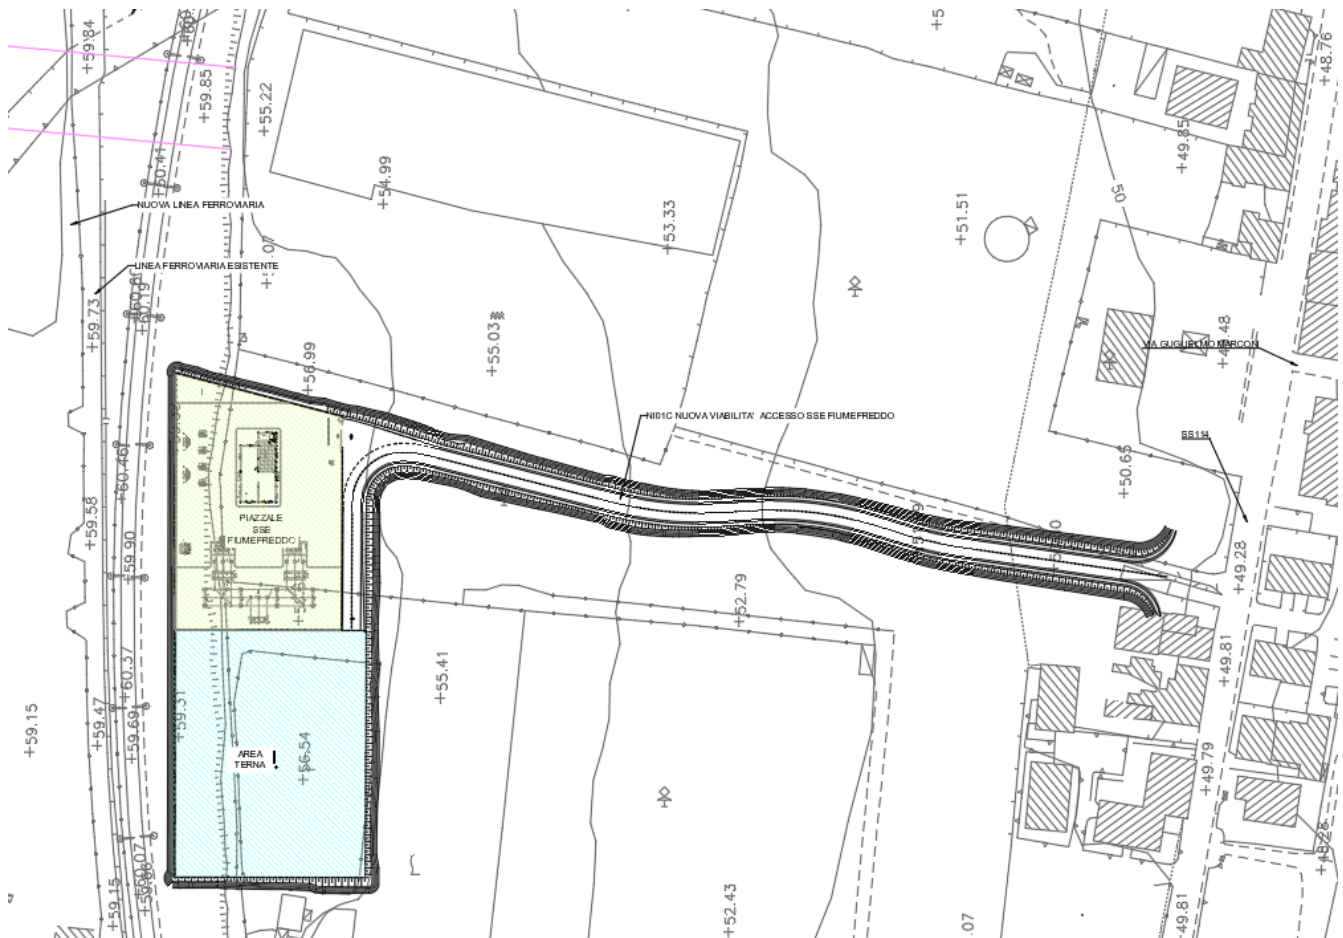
Stralcio planimetria SSE Fiumefreddo (CT)
